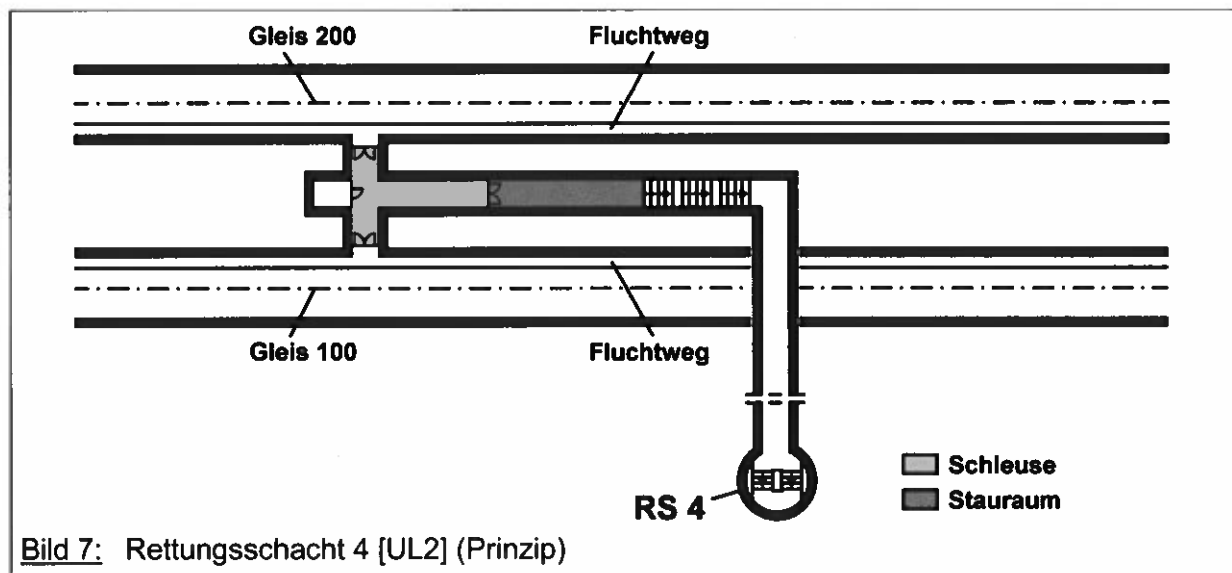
Rettungsschacht 4 [UL2] (Prinzip)
